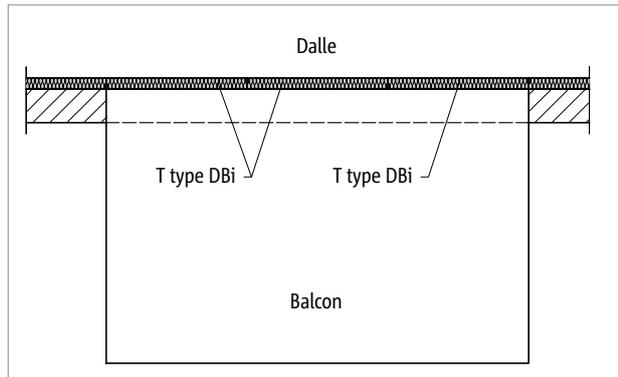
Schöck Rutherma® T type DBi : balcon en porte-à-faux et dalle en béton coulé sur place
